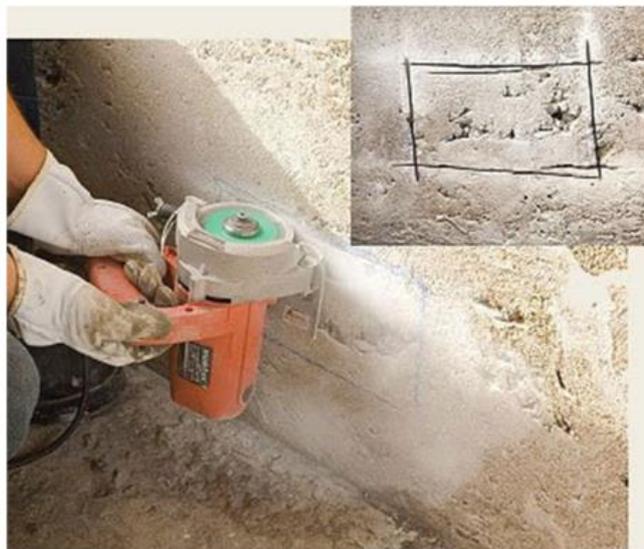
Exemplo de corte em parede de concreto para delimitação da área para intervenção (Fonte: Silveira, 2009)
